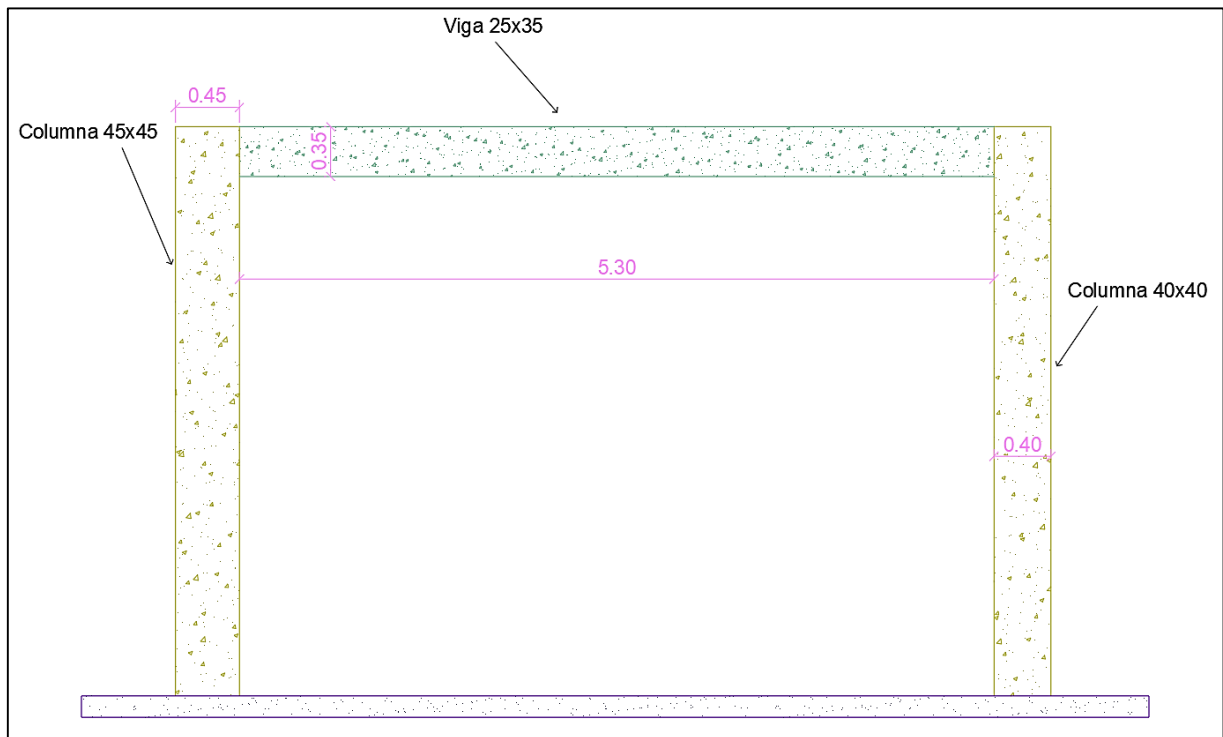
Pórtico seleccionado, vista en corte. Viga y Columnas F7 y F9
